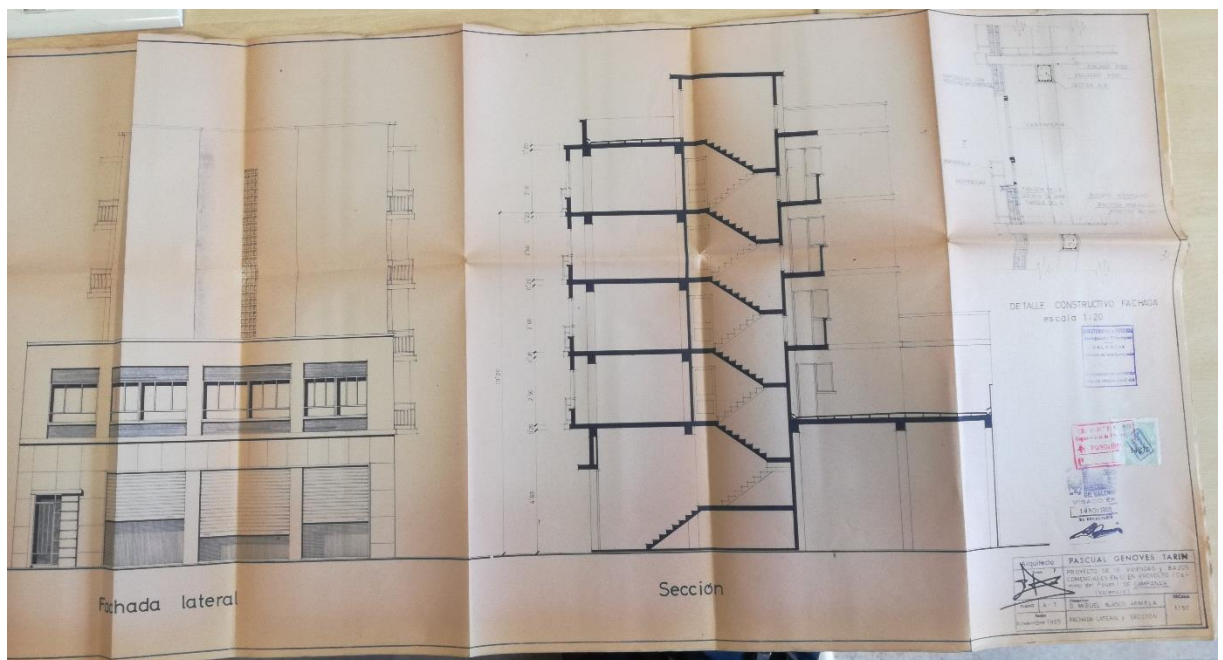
Fachada lateral y sección. Archivo Histórico Municipal
